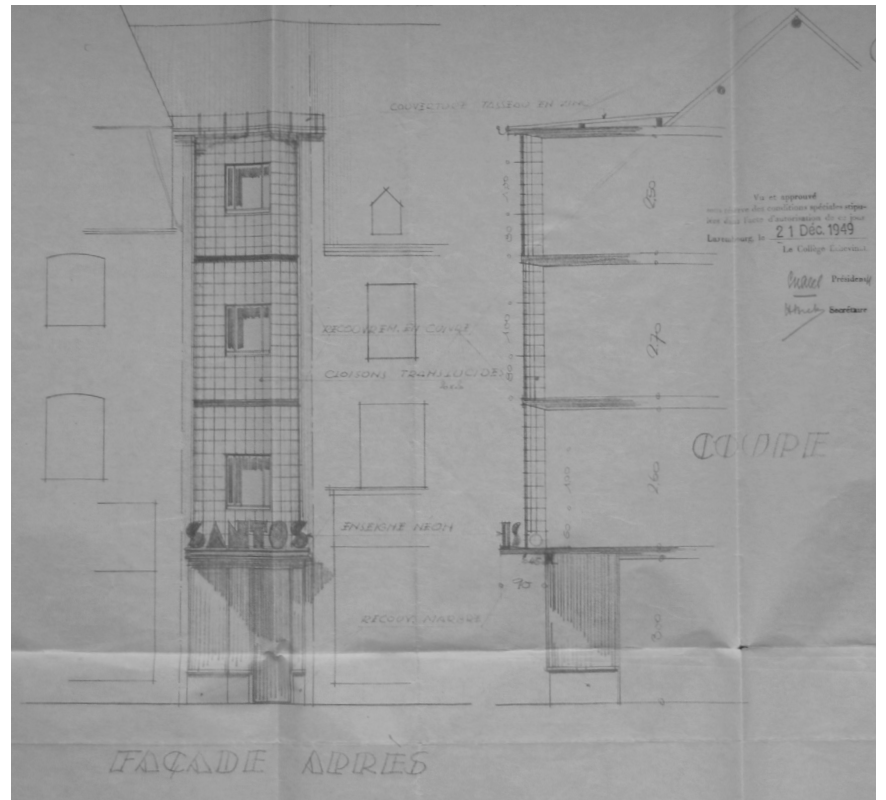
Moderne Glasbaustein-Fassade nach dem Umbau 1949
